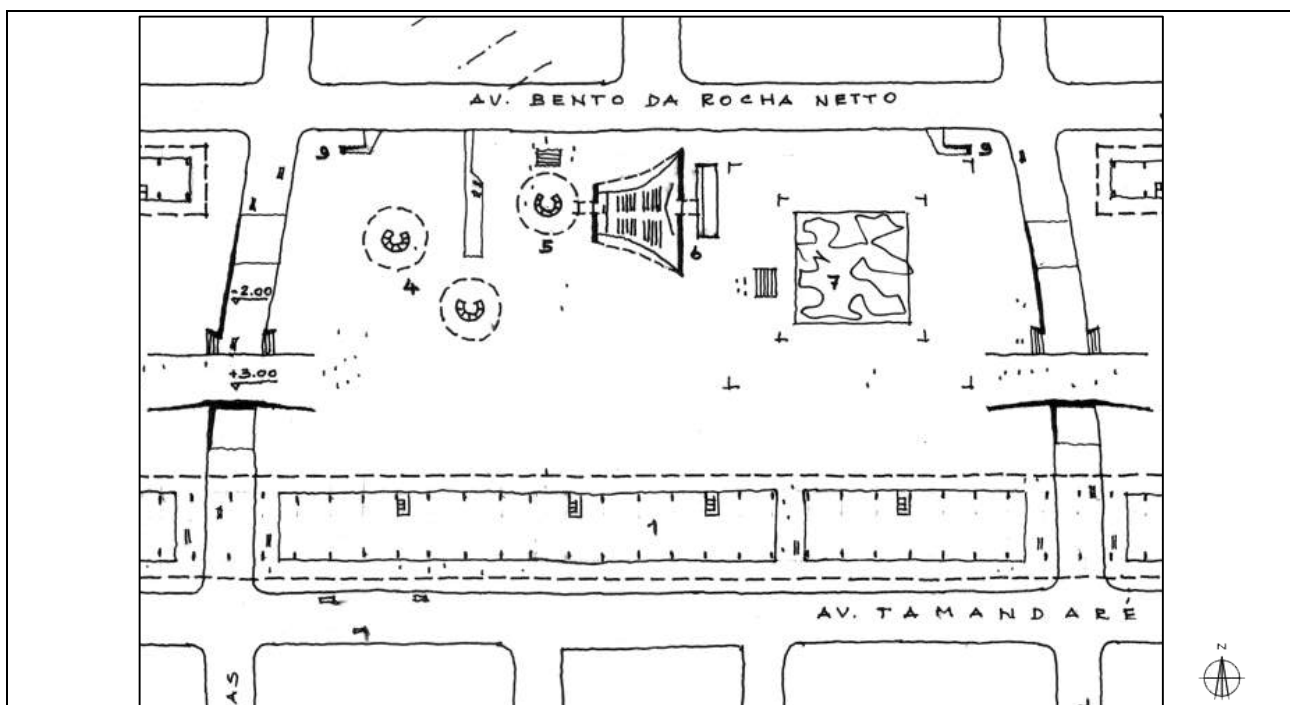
Detalhe pavimento térreo da quadra central do Projeto Ágora 1986.
